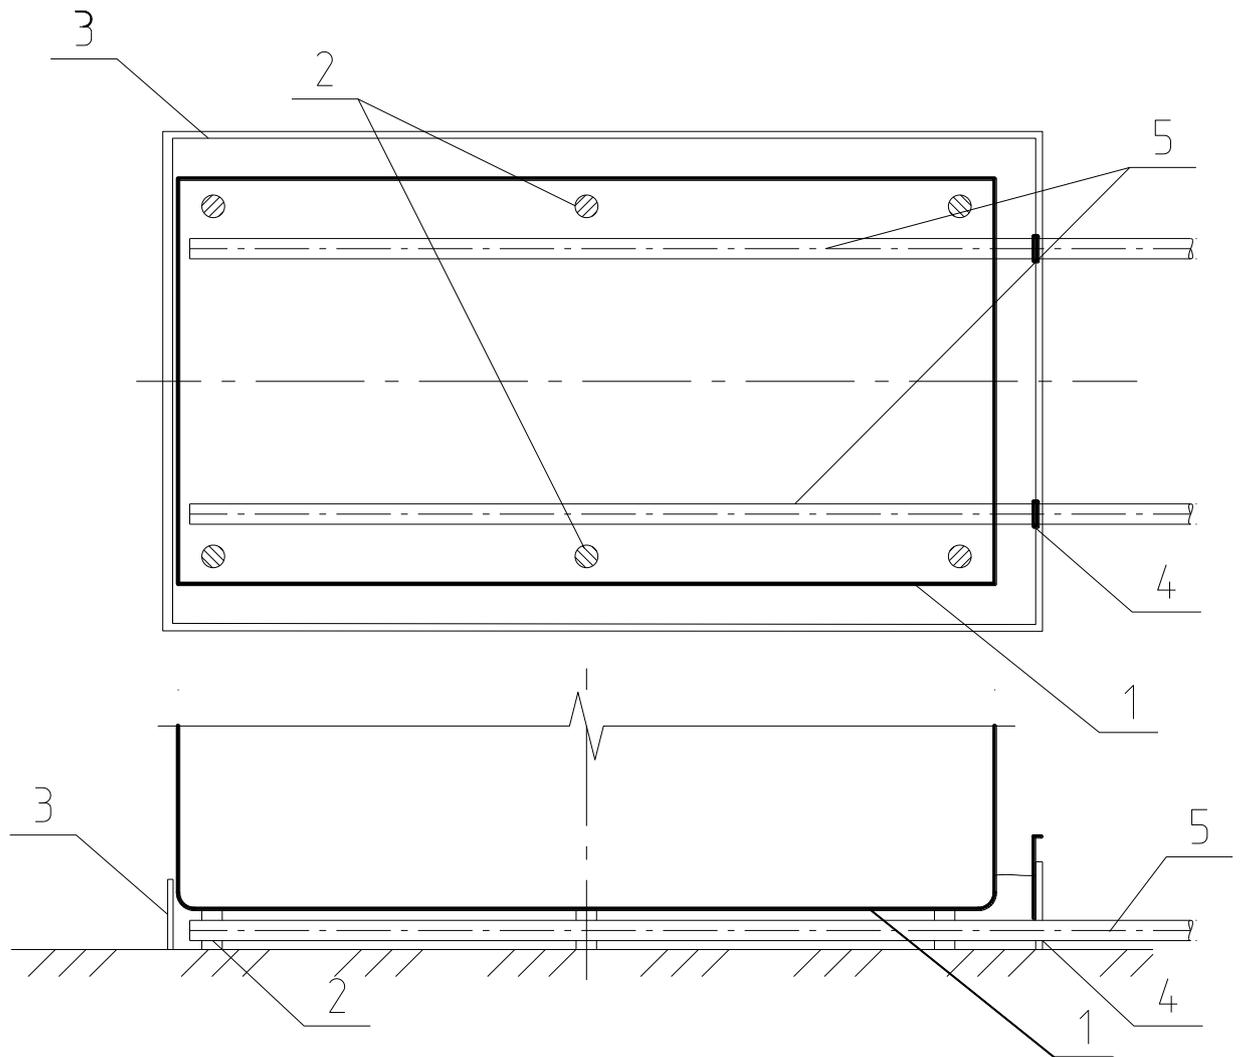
б Схема бетонирования нагнетательным методом от торцевой стороны: 1-оборудование; 2 – опоры; 3 – опалубка; 4 – отверстия в опалубке под бетоноводы; 5 – бетоноводы; 6 – бетонная смесь
